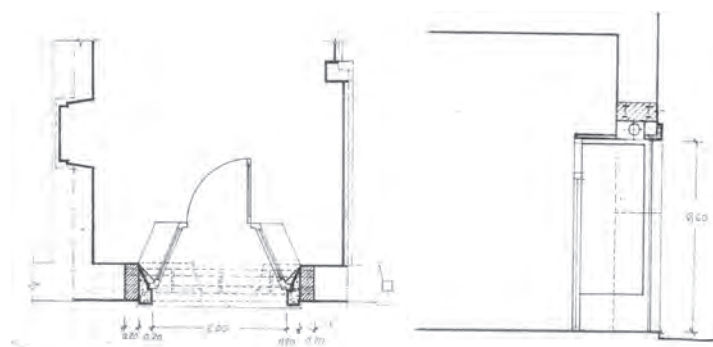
31. PLANTA Y SECCIÓN DEL HUECO PROPUESTO EN MURO DE CARGA²⁸
